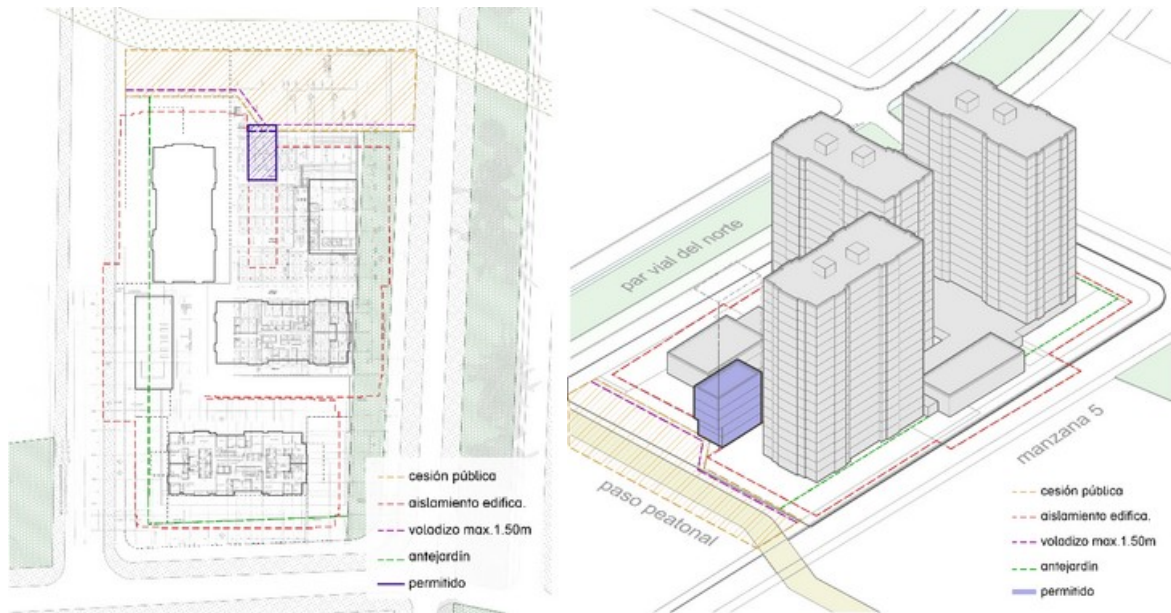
Planta y axonometría de la intervención posible en la manzana 3 siguiendo las Normas Comunes del POT.
